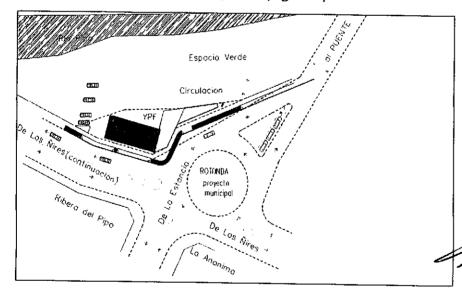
Planta-Anteproyecto Estación de Servicio.
